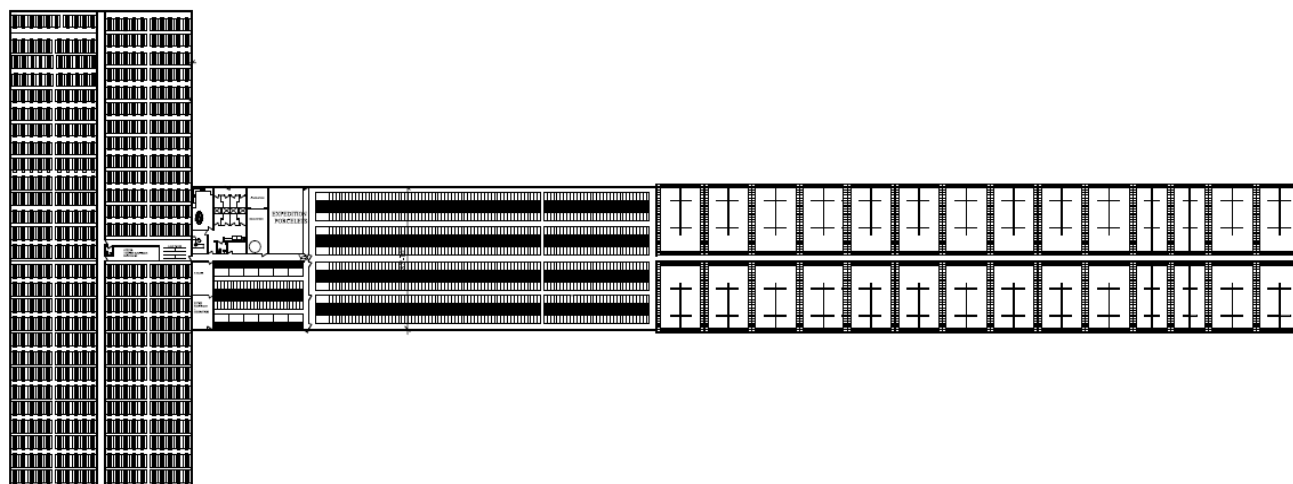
Plan de la maternité de 2 400 truies en groupe avec bat-flancs
